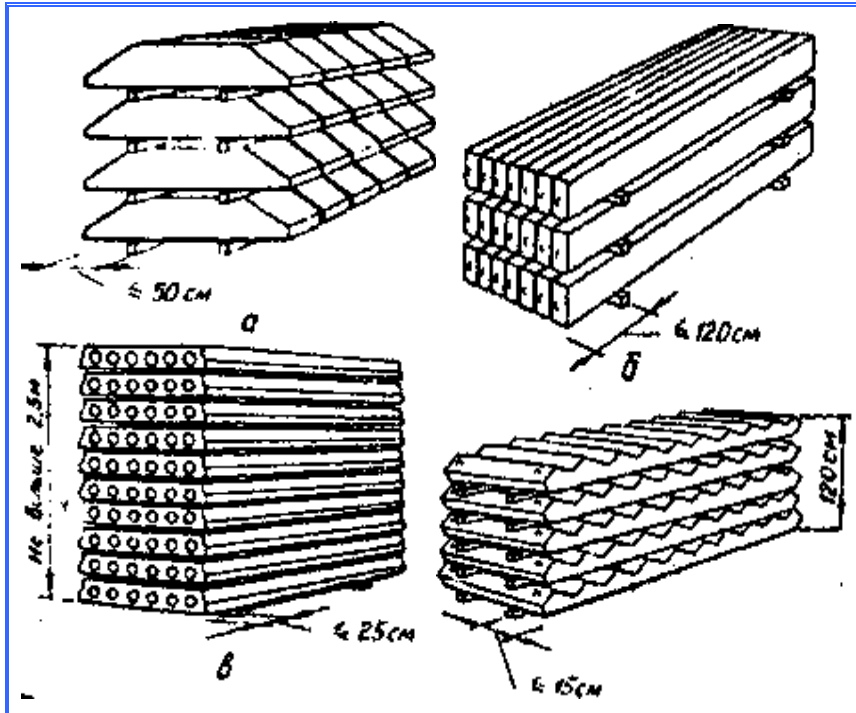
Складування збірних залізобетонних виробів: а – фундаментні блоки; б – ригелі; в – плити покриття; г – сходові марші.
